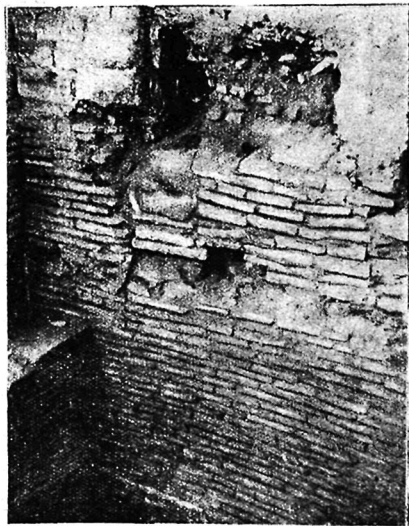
Фундамент здания на южной стороне и закладка дверного проема.
